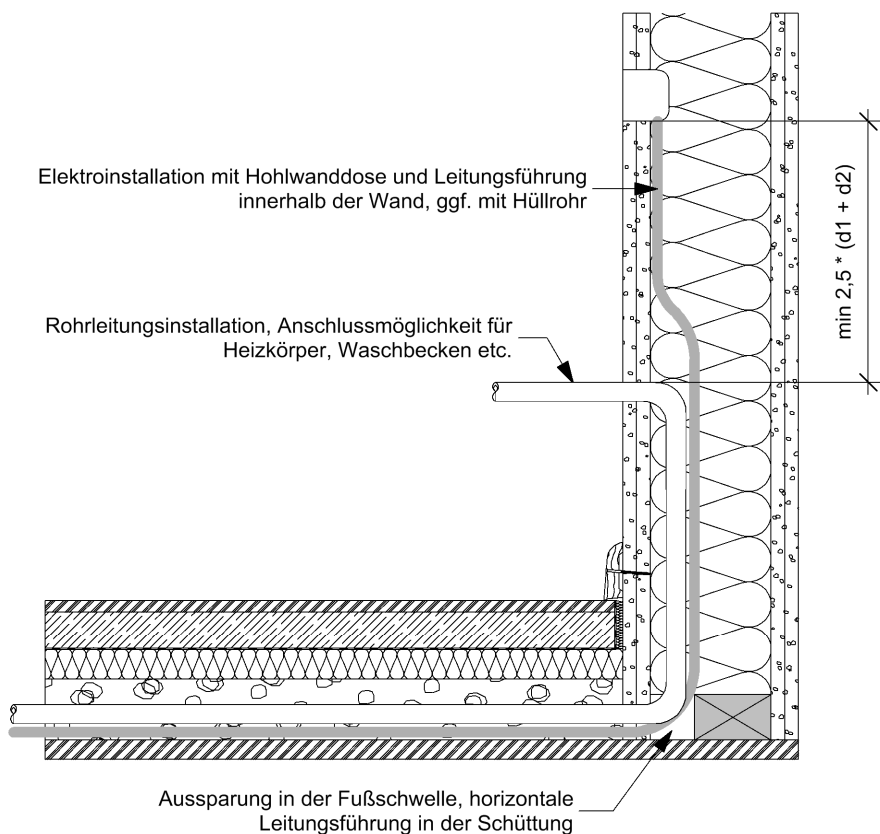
gemeinsamer Einbau von Rohrleitungs- und Elektroinstallationen in Ständerbaukonstruktionen, Leitungsführung im Fußbodenaufbau. Für die Montage sind geeignete Verbindungsstellen in den Leitungen vorzusehen, bzw. Leerrohre einzubauen und die Leitungen nach Wandmontage einzuziehen.
